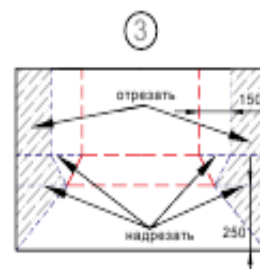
Примыкание кровельного ковра к высокой парапетной стене:
